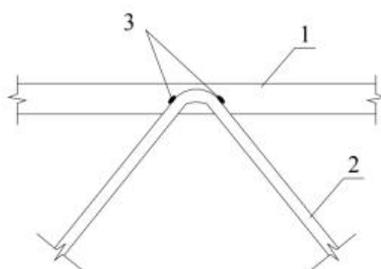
腹杆钢筋弯弧及与钢管焊接要求
